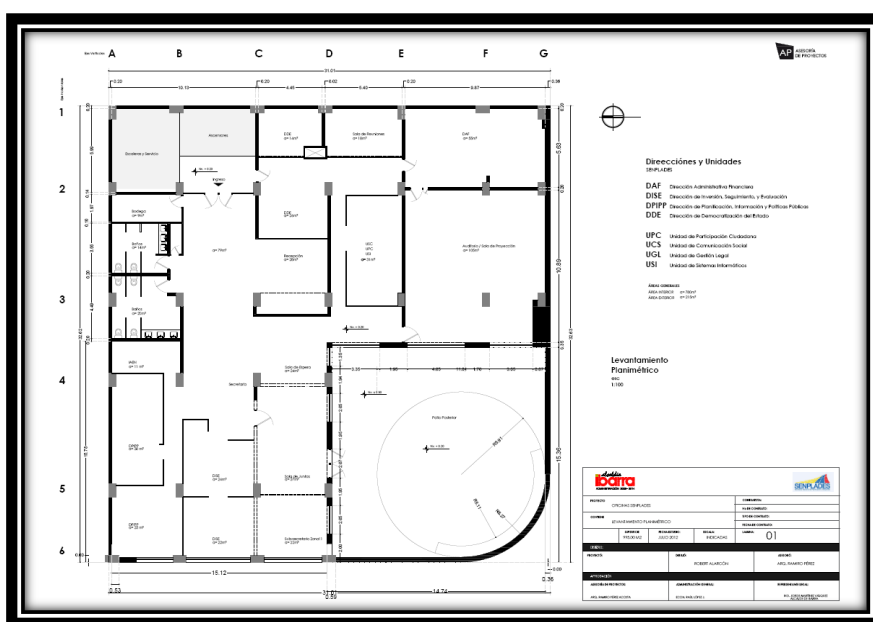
Plano de las oficinas. Fuente: SENPLADES Zona 1 Norte.
